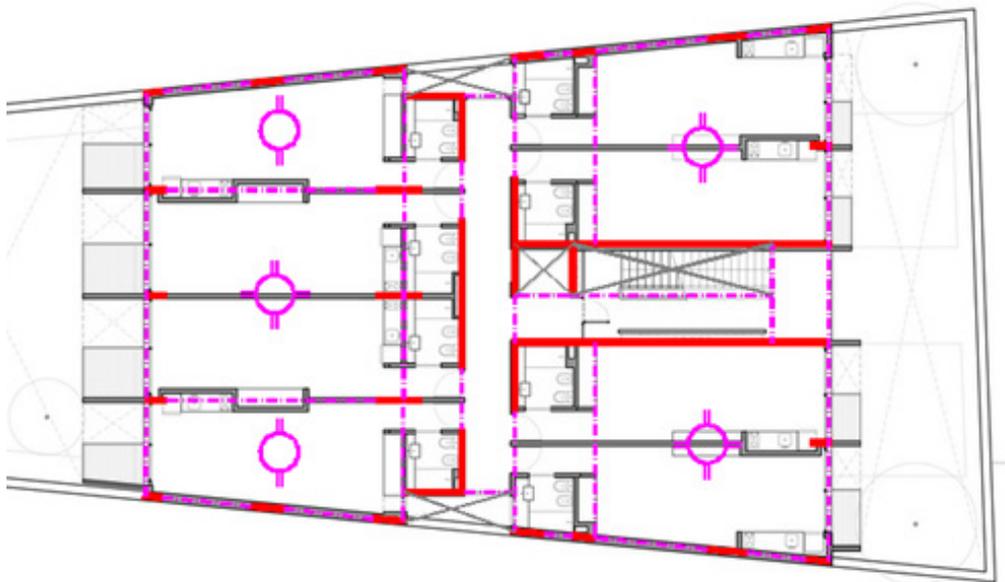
Esquema estructural losa sobre primer piso. Fuente: Elaboración propia
